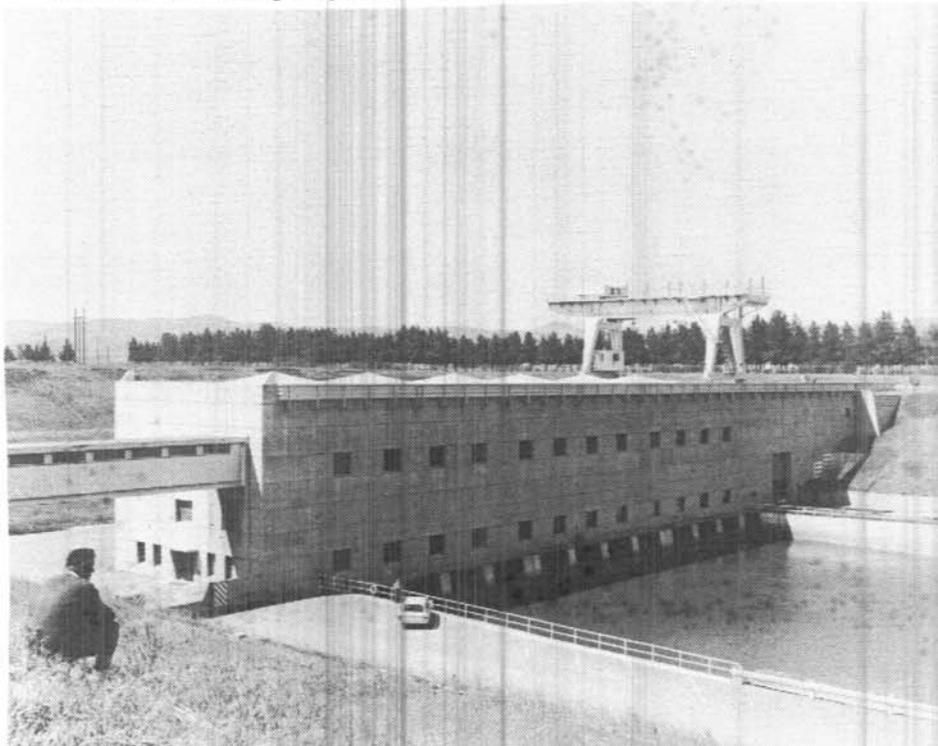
Vista general de la planta de bombeo por el lado de las tomas. 14/4/66
